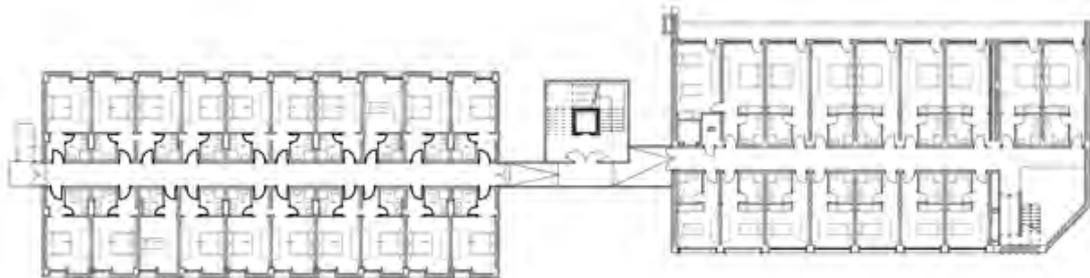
pianta del primo piano dell'Hotel San Faustino
